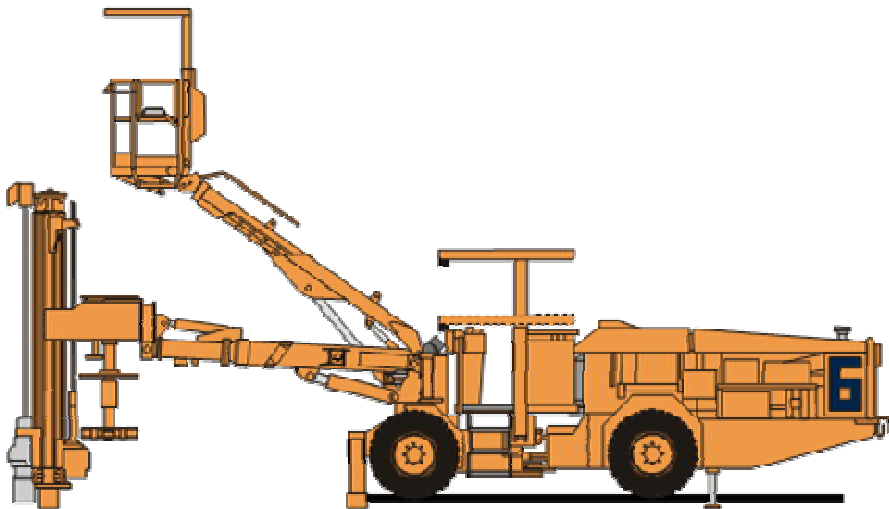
Общий вид установки для крепления анкерами Robotolt 6-126 XL Basket
